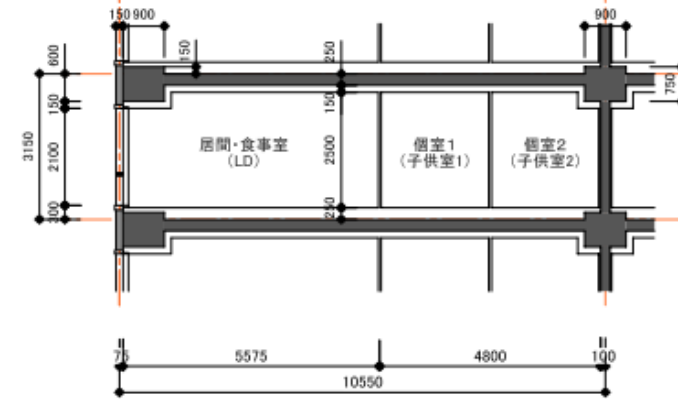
3LDKリビング横長モデルの平面図・断面図
